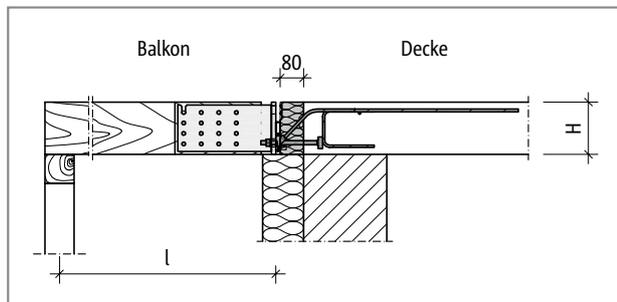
Schöck Isokorb® T Typ SQ mit Stahlschwert: Statisches System
